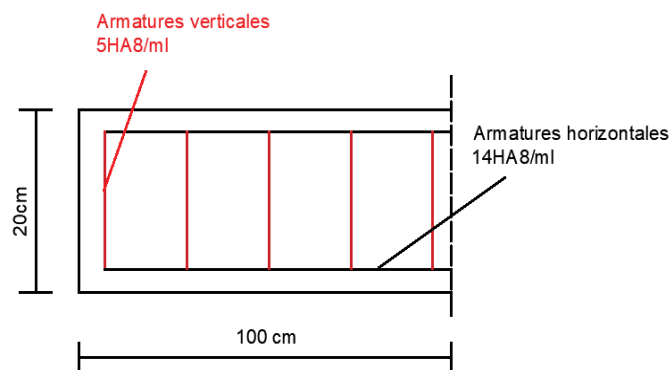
Vue en plan du ferrailage de l'acrotère selon le CBA 93.
